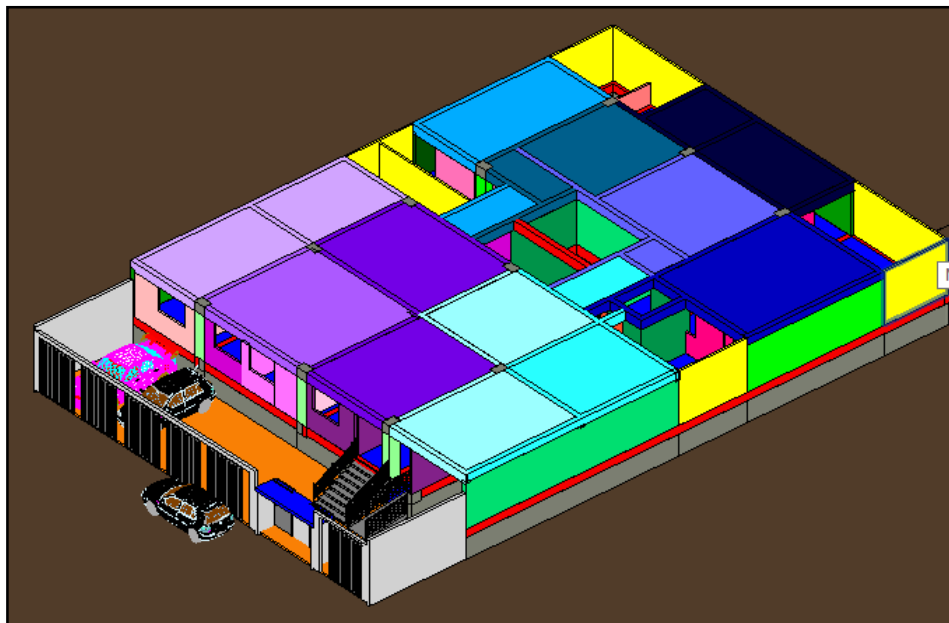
Avance diario BIM de losa maciza y vigas – 1er piso
